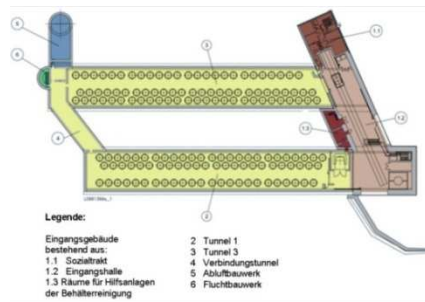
Plan de masse de l'entreposage en tunnel de Neckarwestheim (Allemagne)
